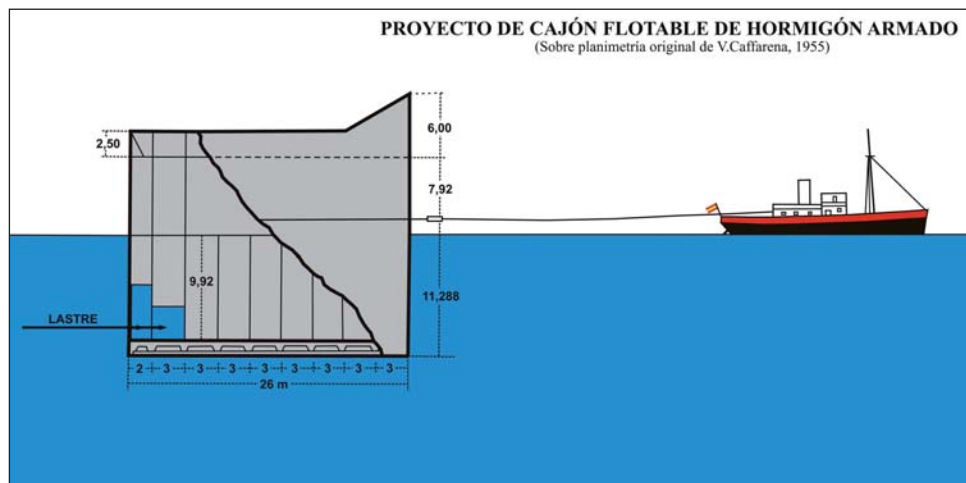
Plano del proyecto con el cajón flotable de hormigón armado dispuesto originalmente en punta para su remolcado (sobre planimetría original, CAFFARENA 1955:111).
